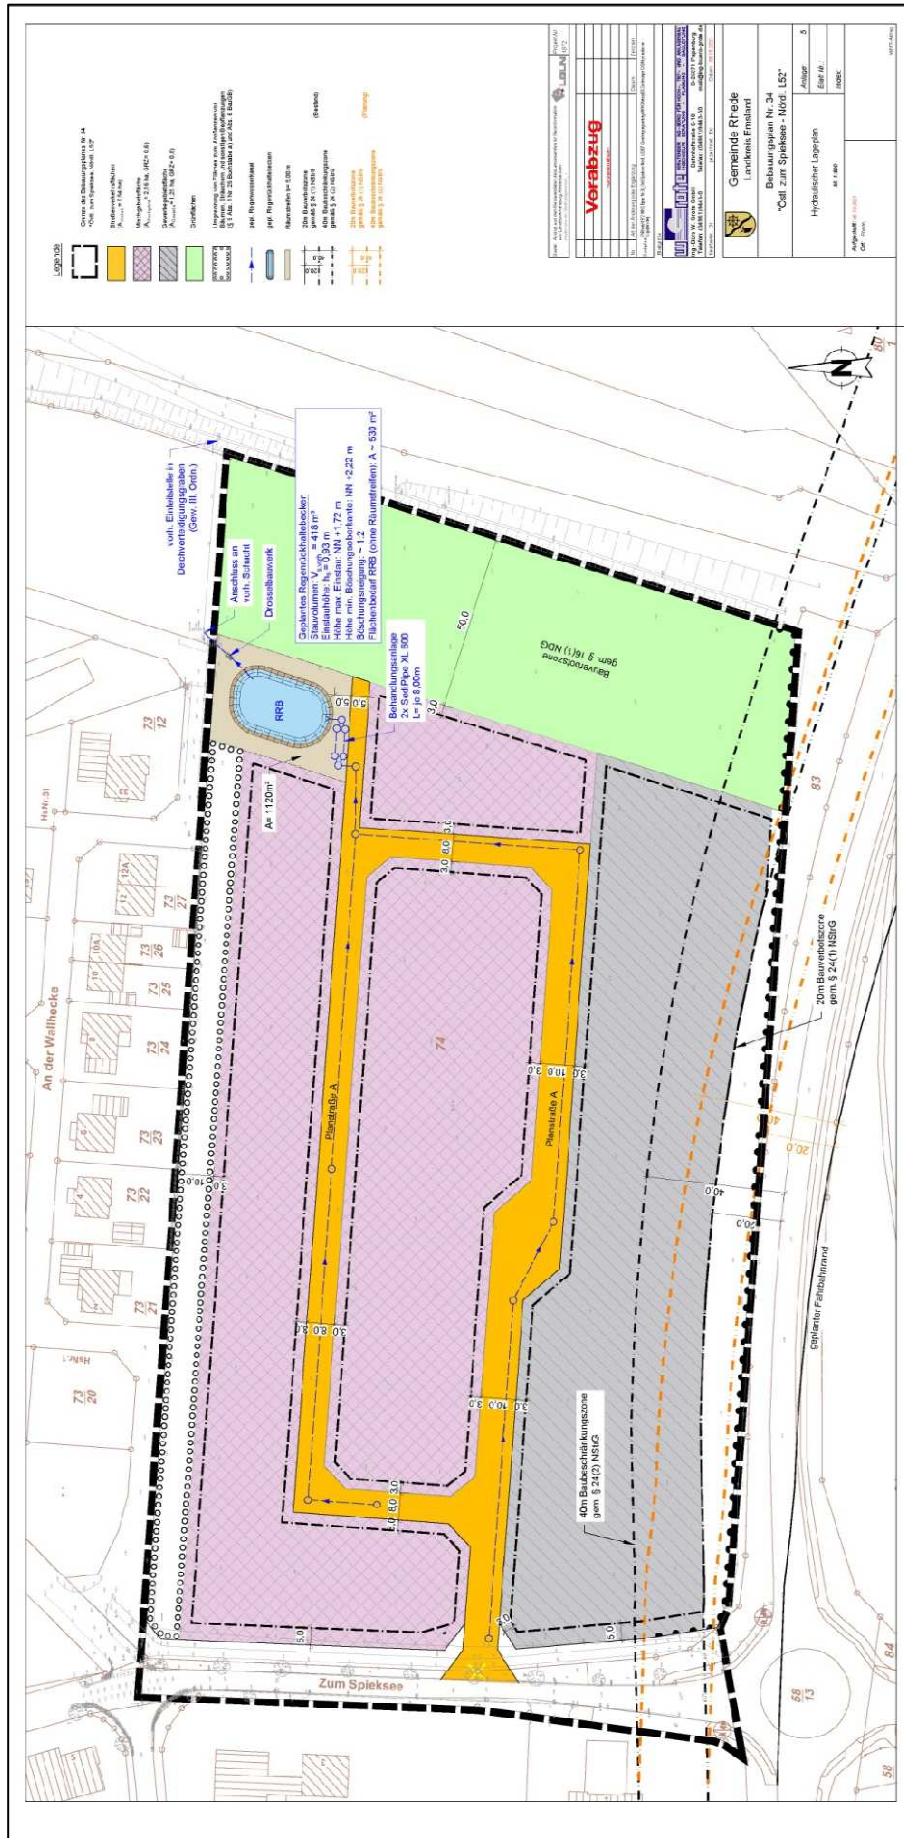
Hydraulischer Lageplan (Entwurf)
